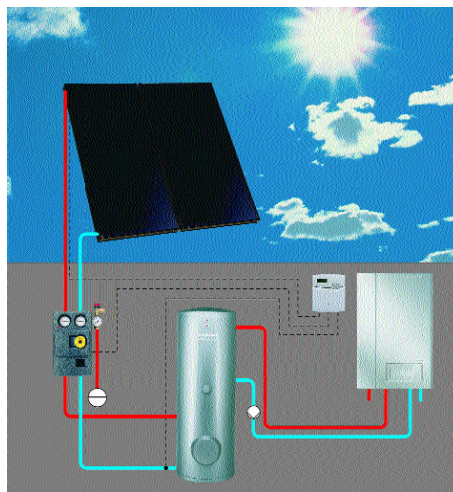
Płaskie cieczowe kolektory słoneczne zamontowane na połaci dachowej
